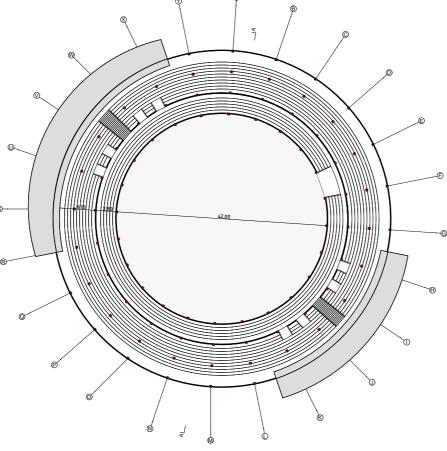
Planta de la plaza de Toros Santa Ana Fuente: elaboración propia.
